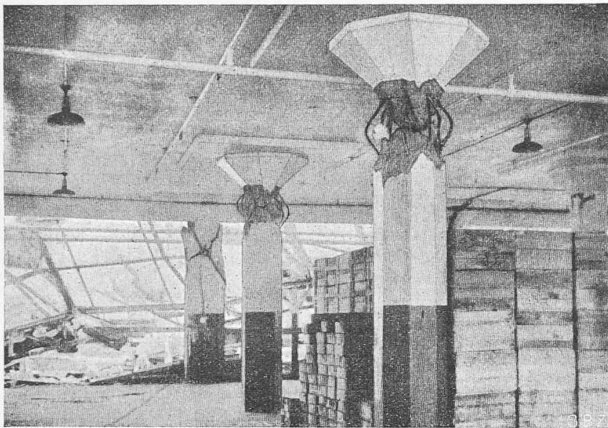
Zerstörung eines Eisenbetonbaues durch Erdbeben in Japan, Sept. 1923.
